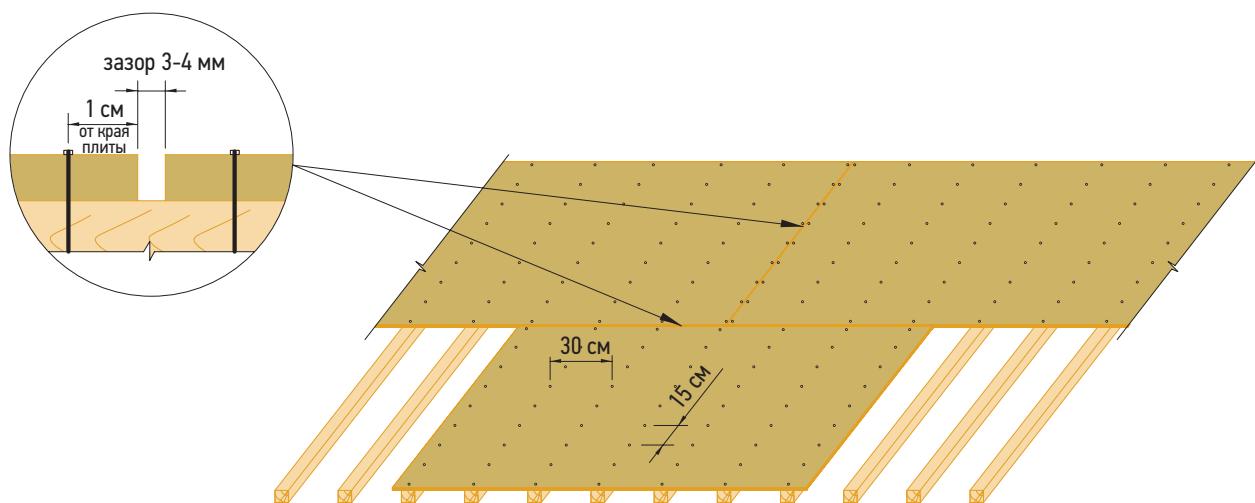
Монтаж сплошного основания из ОСП-3/ФСФ
